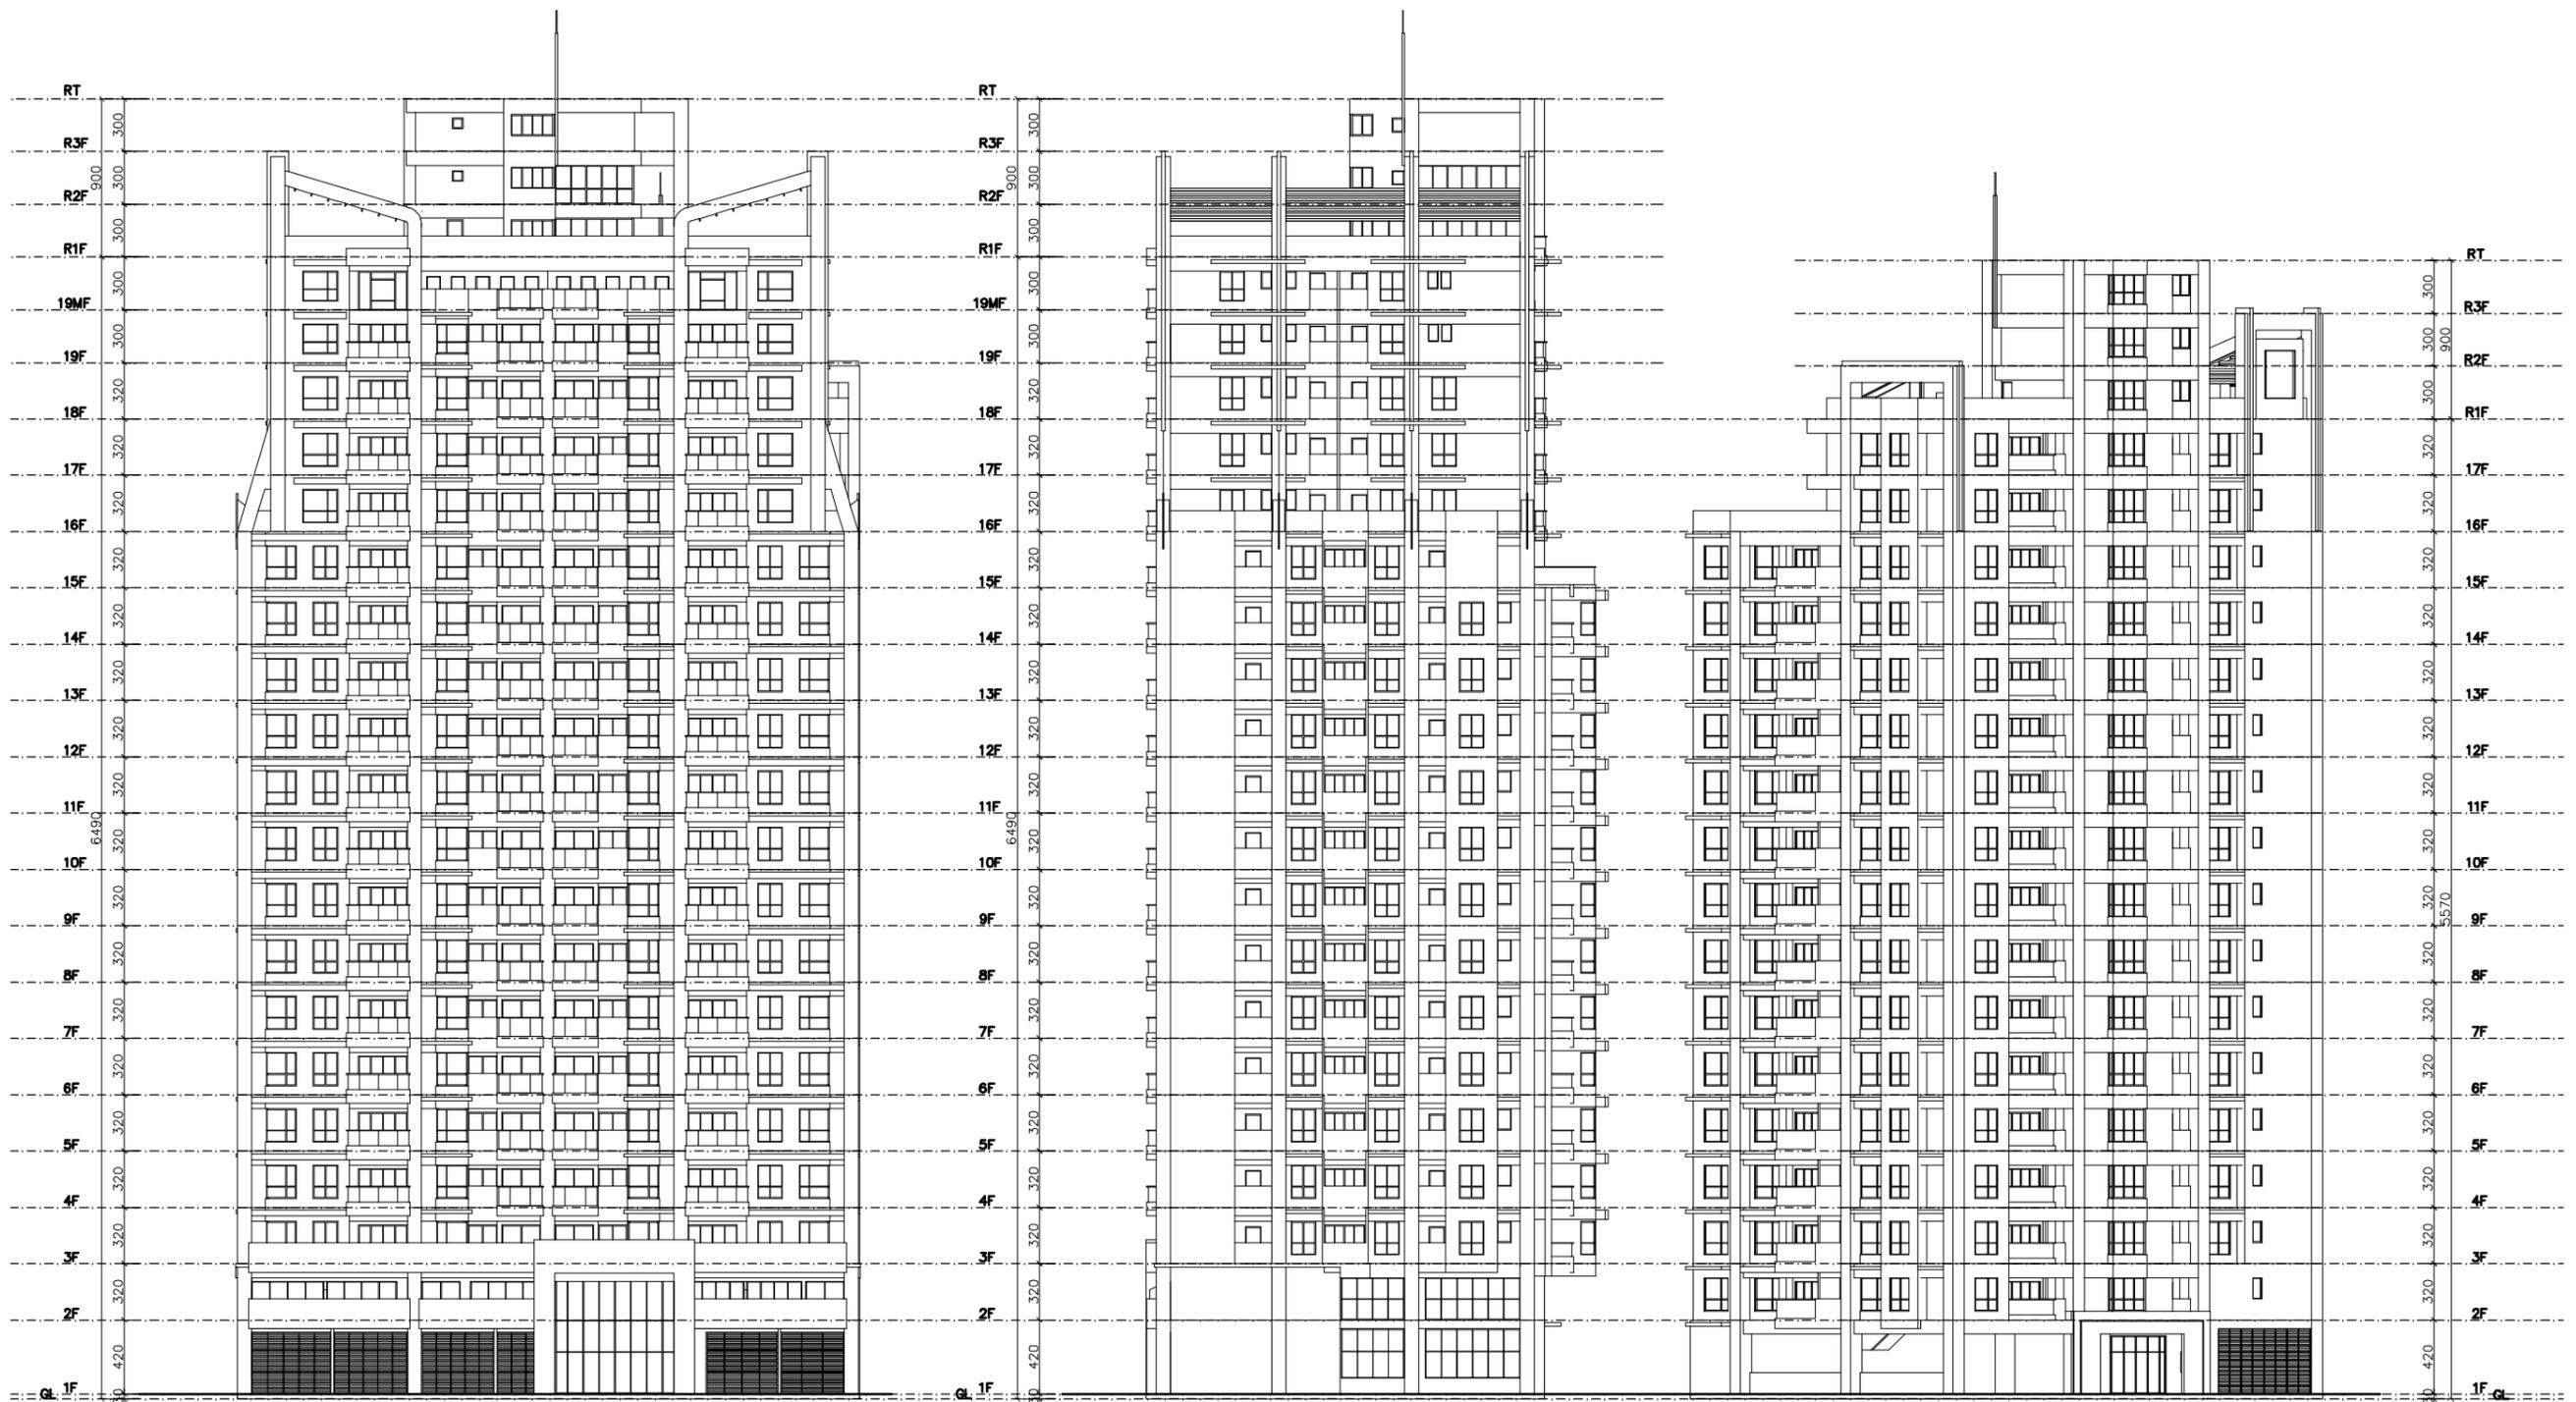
B 棟左向與右向立面圖 1 左向立面圖 S:1/400
